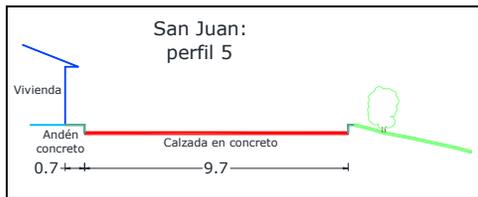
Perfil 5 Vía Local en concreto Centro Poblado San Juan
